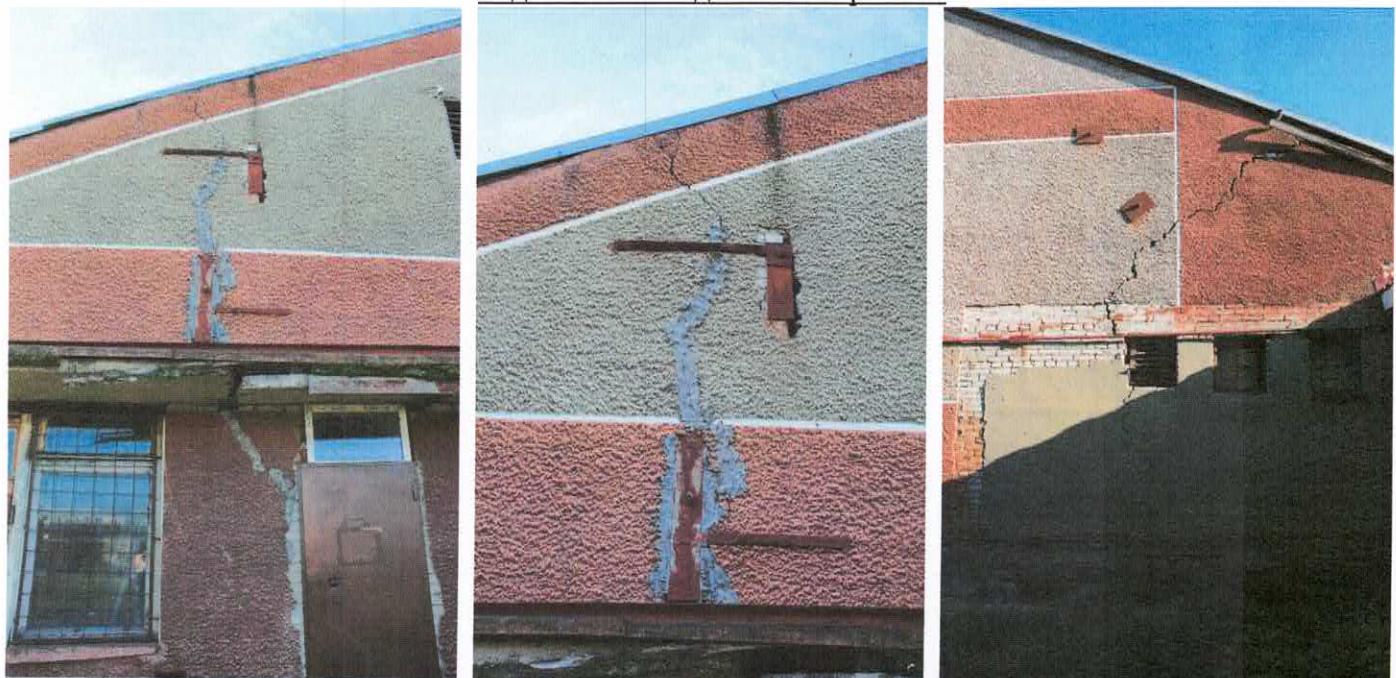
Наличие трещин в кладке наружных стен и фронтона
